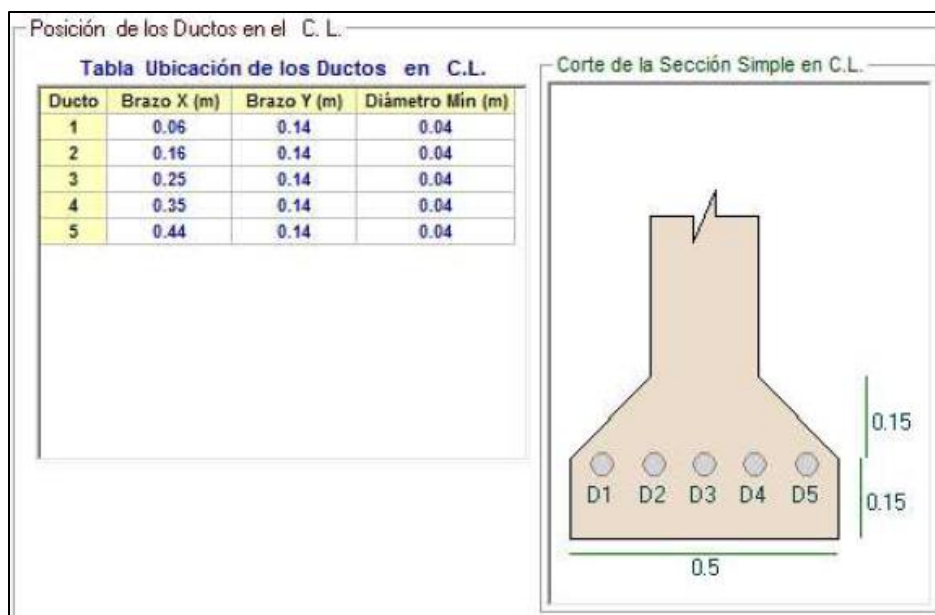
Detalle de la instalación de los cables en el centro de la luz.
